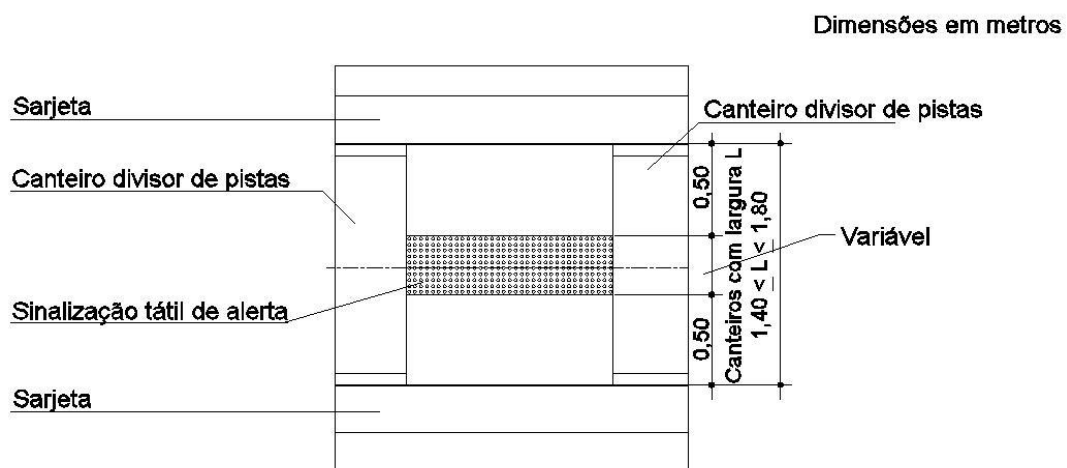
Rebaixamento de canteiro divisor de pistas $1,40 \text{ m} \leq L \leq 1,80 \text{ m}$
